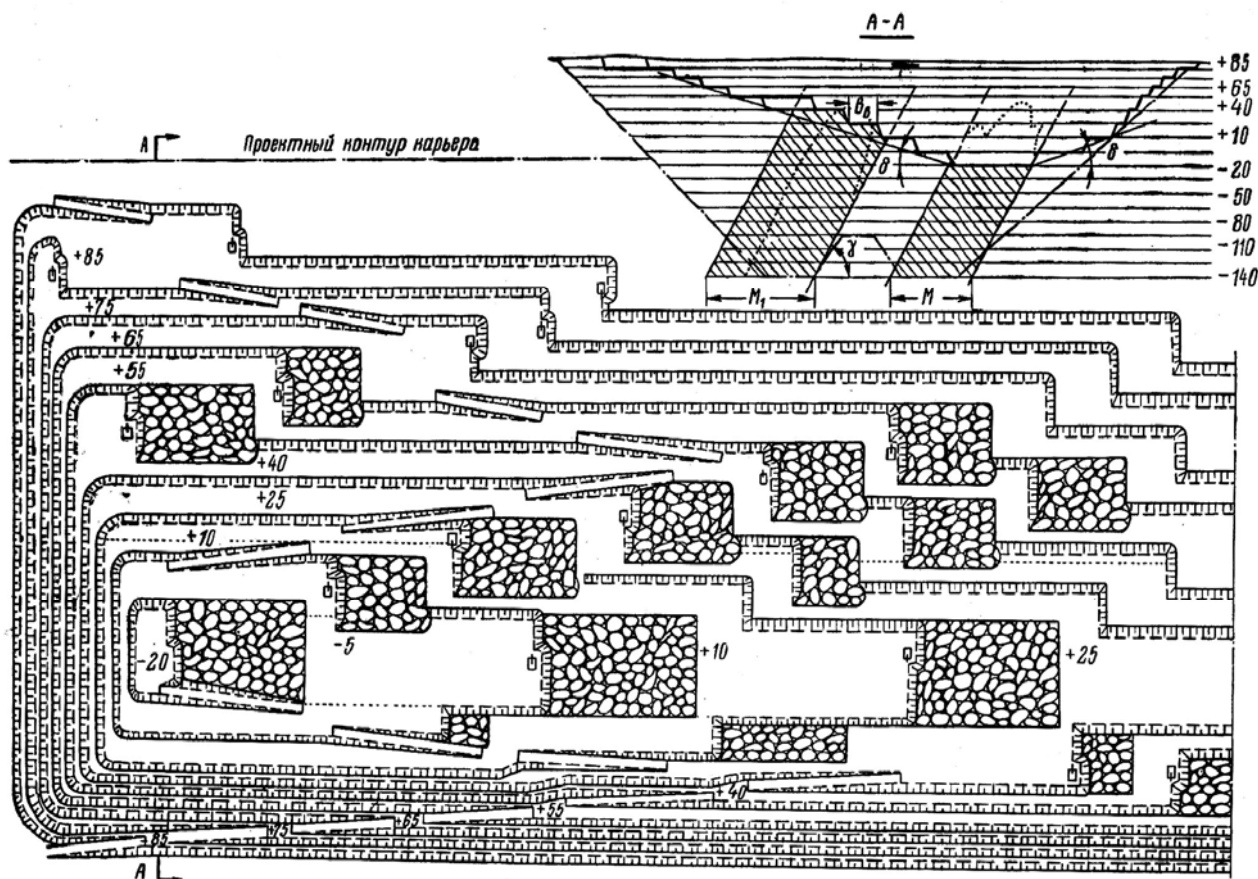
Схема разработки месторождения поперечными заходками без разрезных траншей
